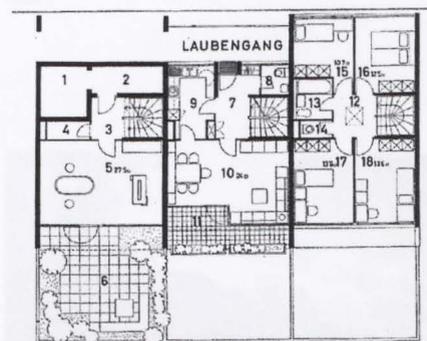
Hans Riehlgasse A. Grundriss
